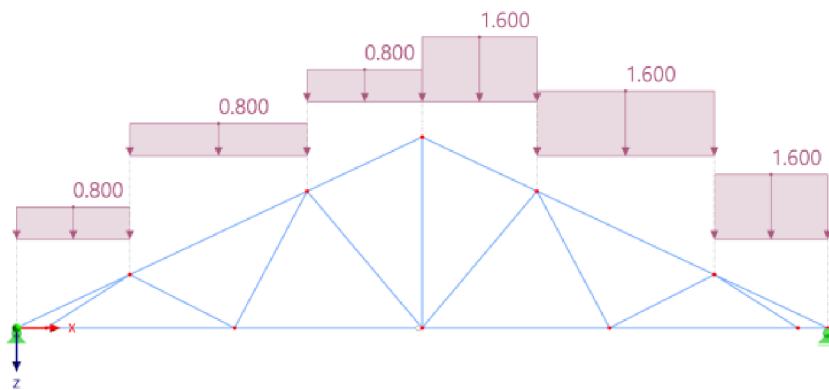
Zatížení skladbou střešní konstrukce
